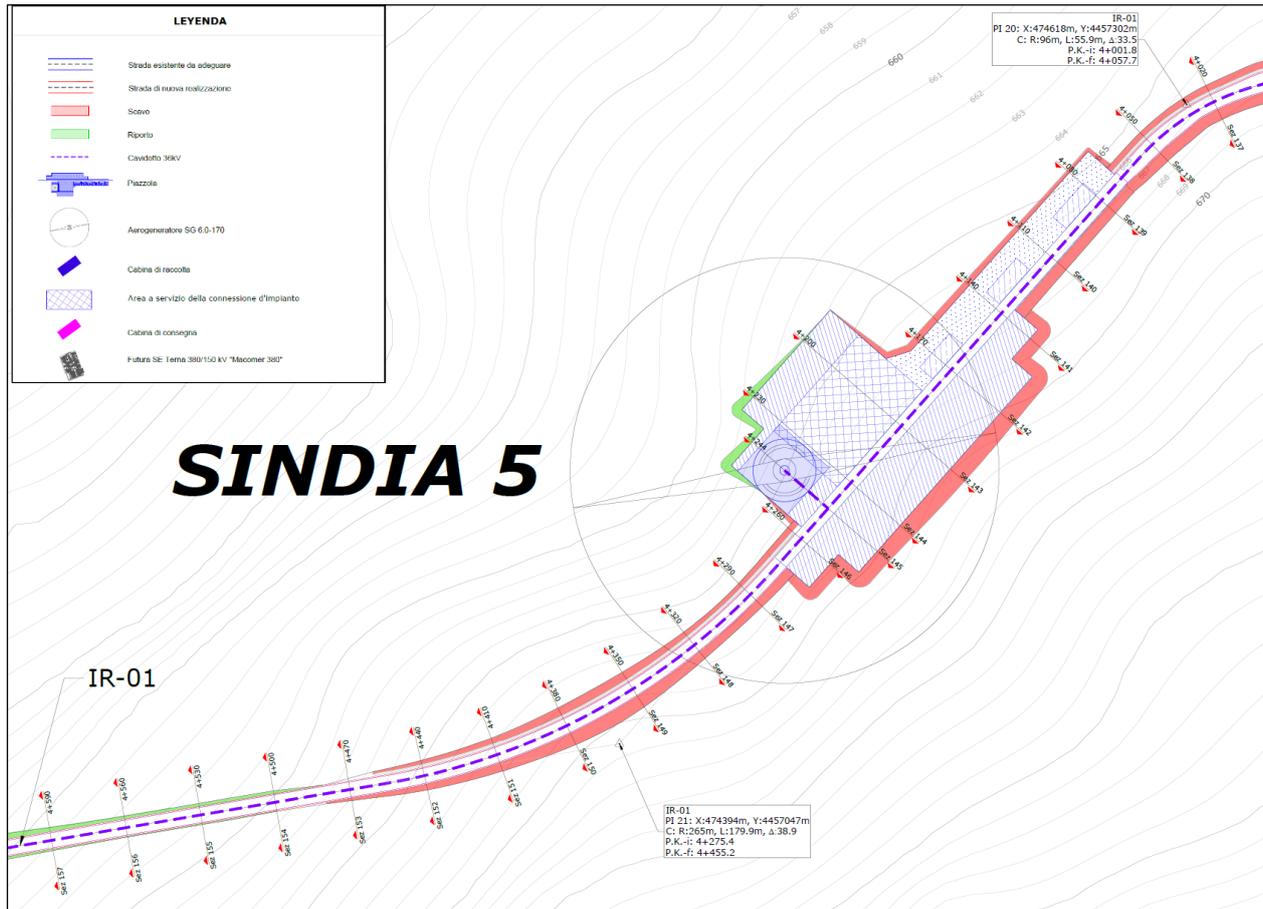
Tracciato planimetrico viabilità di nuova realizzazione.
